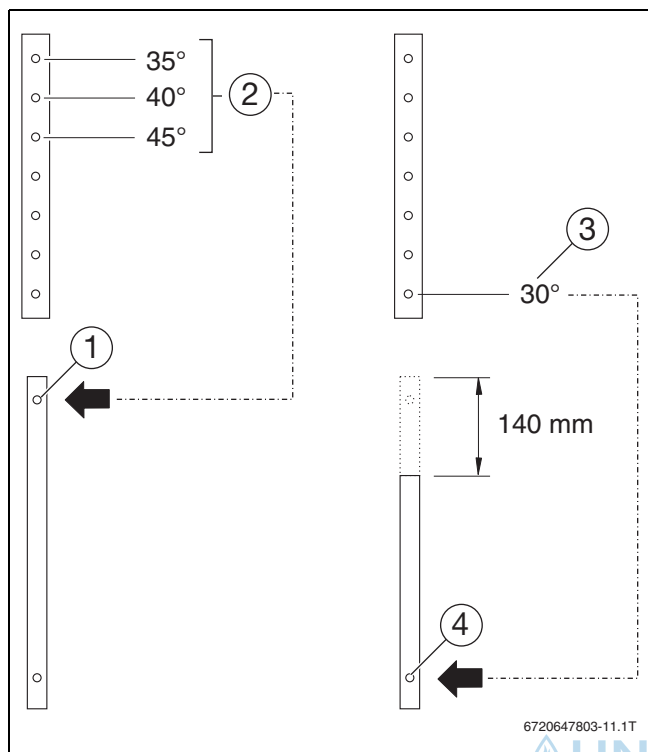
Fassadenmontage, Kollektortyp waagrecht
